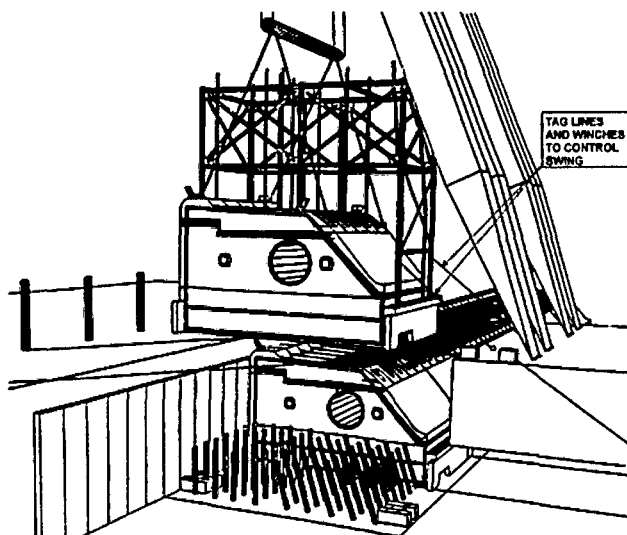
Mise en place d'un élément préfabriqué d'un barrage mobile par un système de levage
